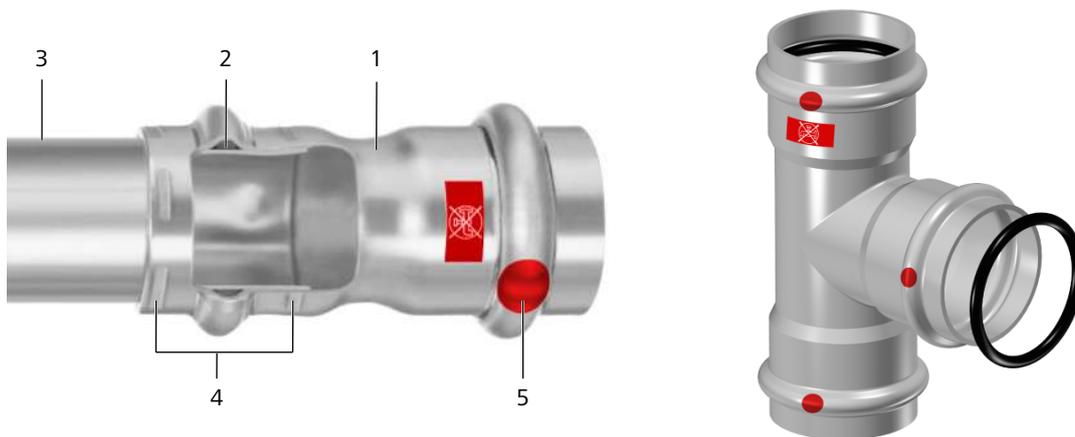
Assemblage par sertissage Optipress-Therm jusqu'à Ø 15 à 54
